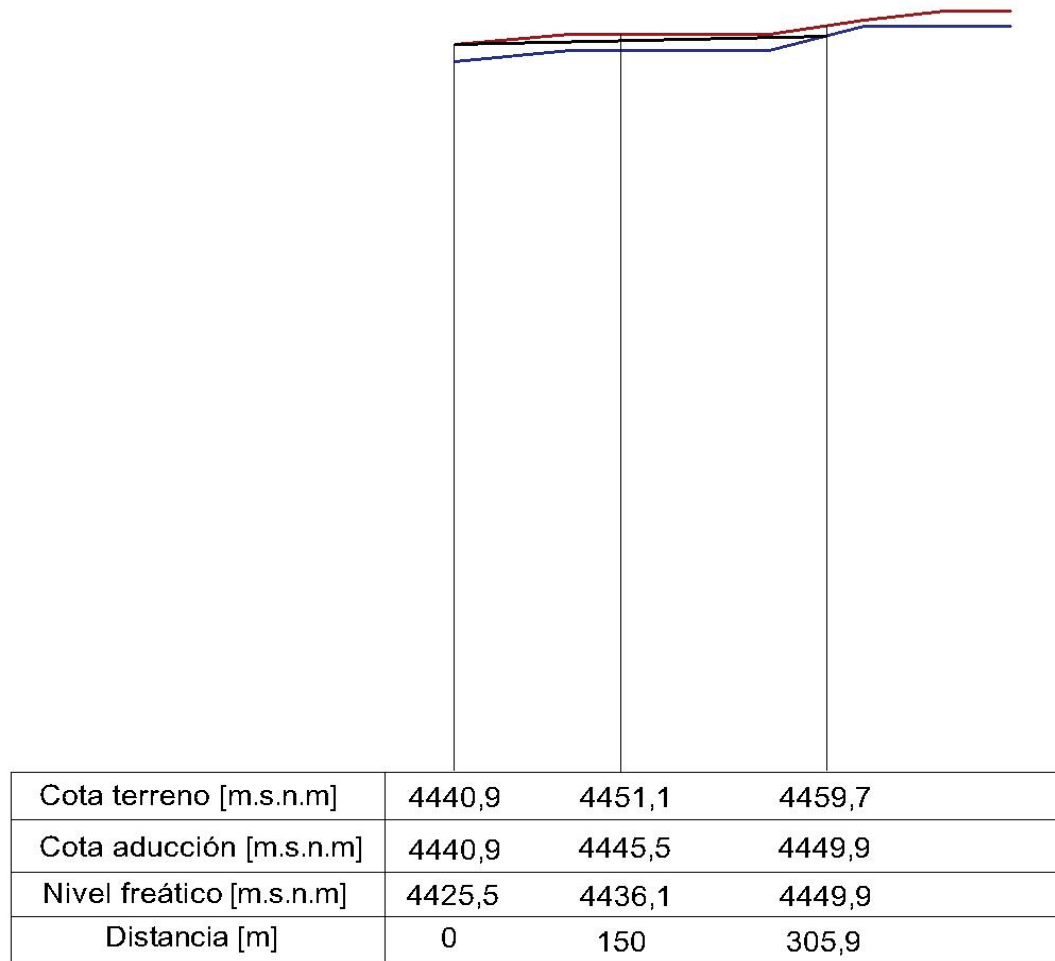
Perfil longitudinal de aducción en Quebrada 4 - 1.
